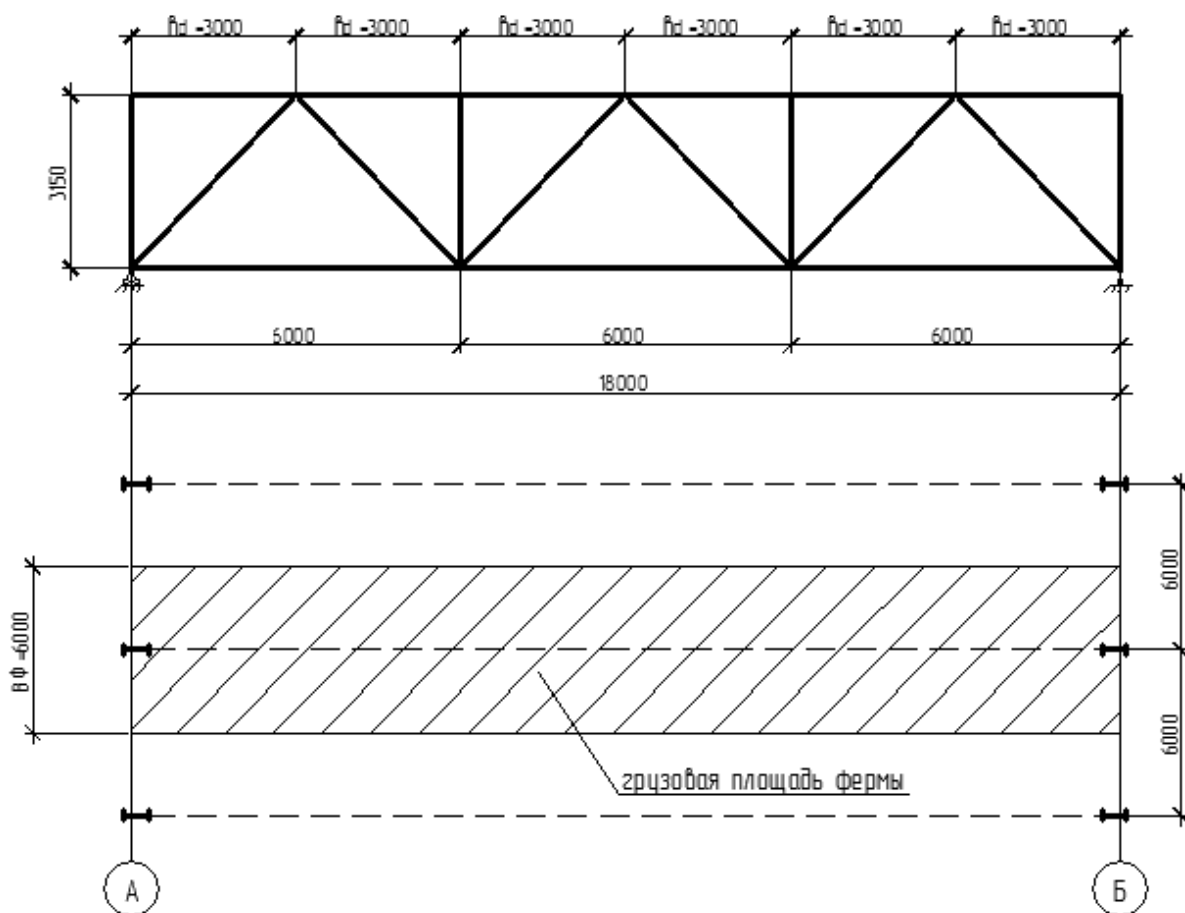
Расчетная схема и грузовая площадь фермы
